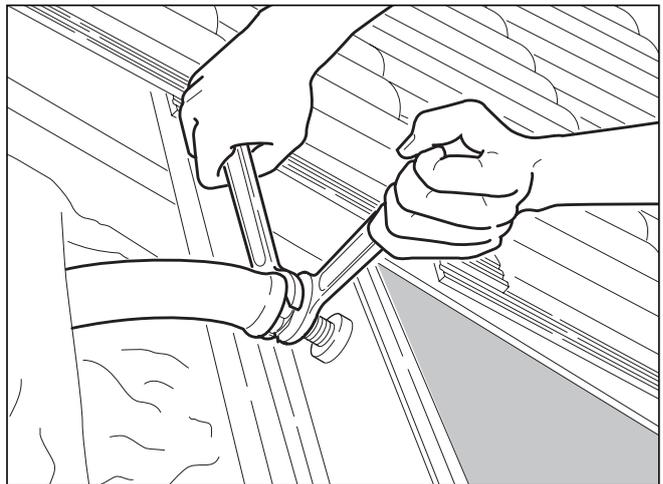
Подключить соединительные трубы коллектора (арт. № 302 384 и 302 385) к свободным разъемам коллектора, а под крышей - к медным трубам контура гелиоустановки (с 1/2"-18 мм ниппелем). Опрессовать соединения, если позднее нижняя часть крыши будет закрыта.
